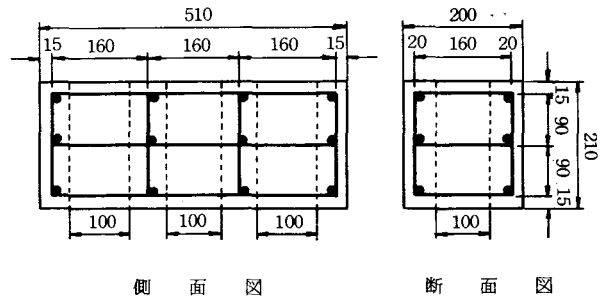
拘束コンクリート用供試体の形状・寸法および配筋図 (単位: mm)
